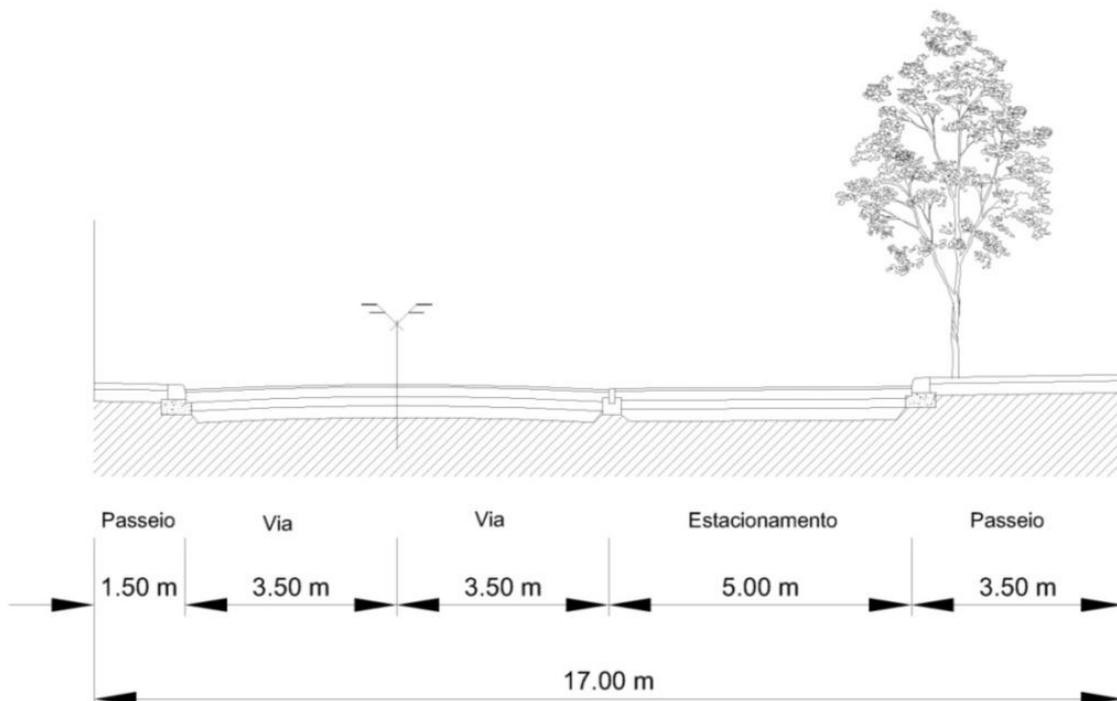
Perfil Transversal Tipo da via da Aldeia Luís Francisco
